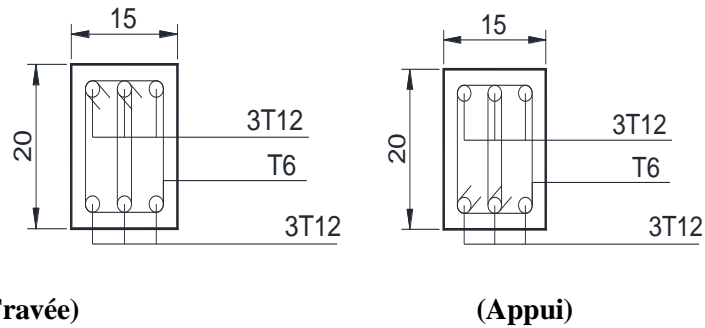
Ferrailage d'une poutre noyée secondaire 15x20cm (plan fortement irrégulier)
